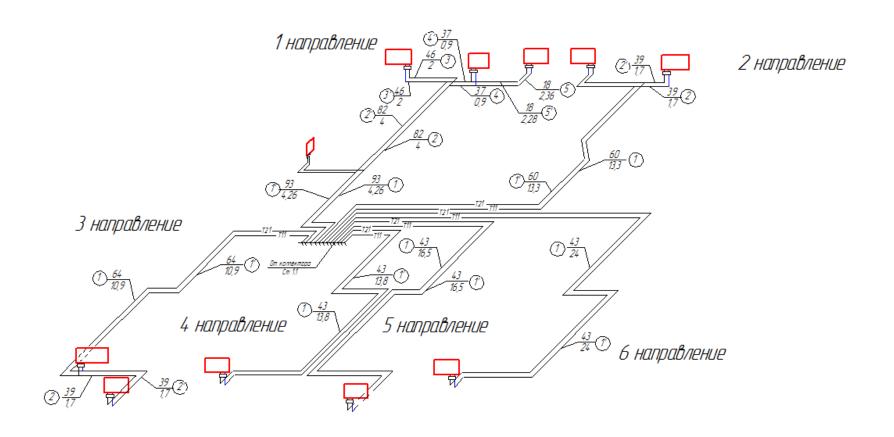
Расчетная схема поквартирной разводки 1-го этажа (БС-1)
